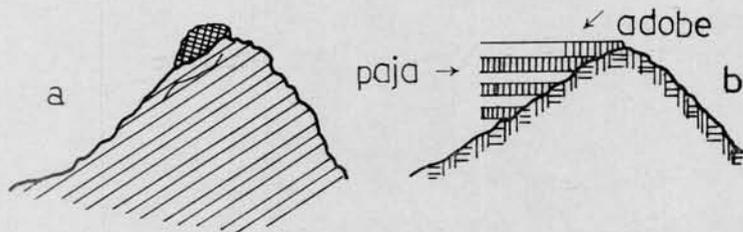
Detalle del ensanchamiento del camino que lleva al cerrito fortificado. Tomado de Weisser, 1925. *a*, Obra de refuerzo vista a lo lejos; *b*, Detalle de la obra de refuerzo de capas y adobes superpuestas.
